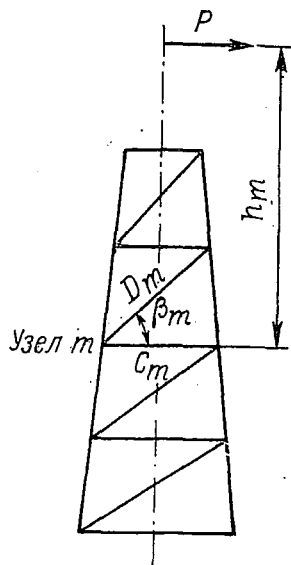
Расчетная схема для определения усилий в ферме с раскосной решеткой
